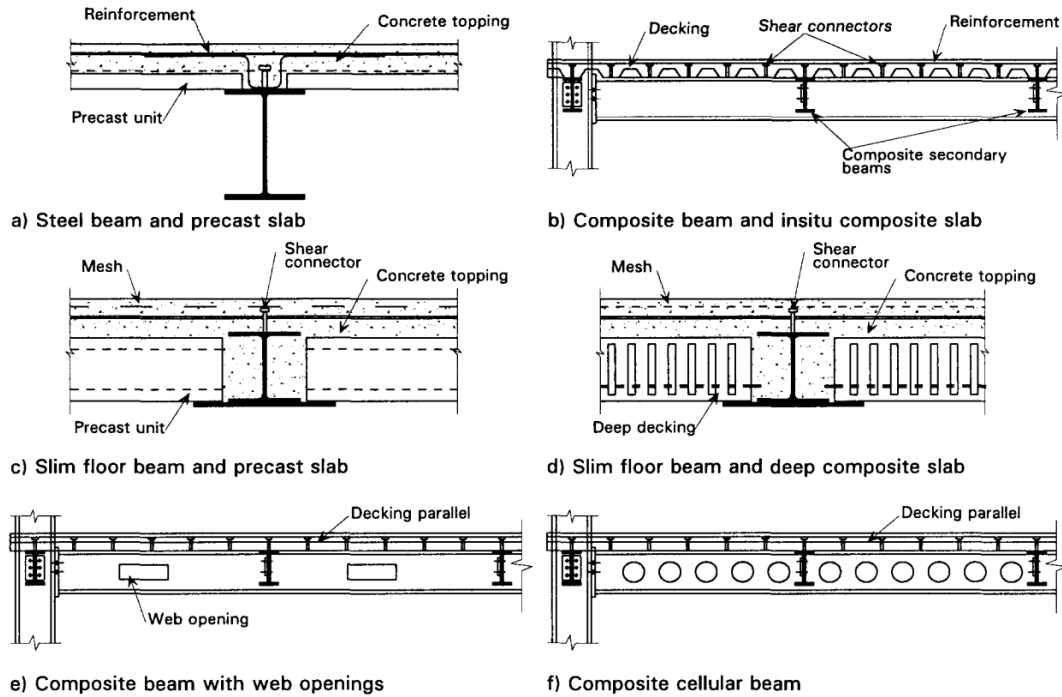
Sistemas estrutural em construção mista 1/2 (Brown *et al*, 1997).
